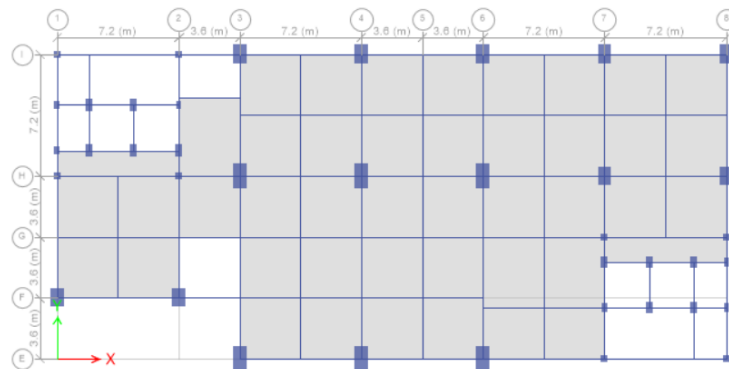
Denah Lantai 4-12 Gedung Tower 3 ITS Surabaya
